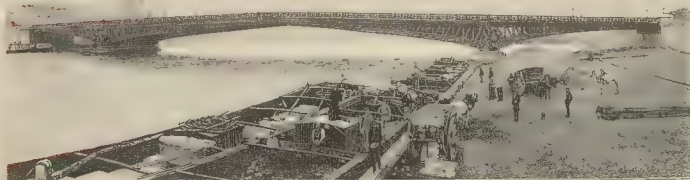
Vista en conjunto del puente Mirabeau, recientemente inaugurado en París
